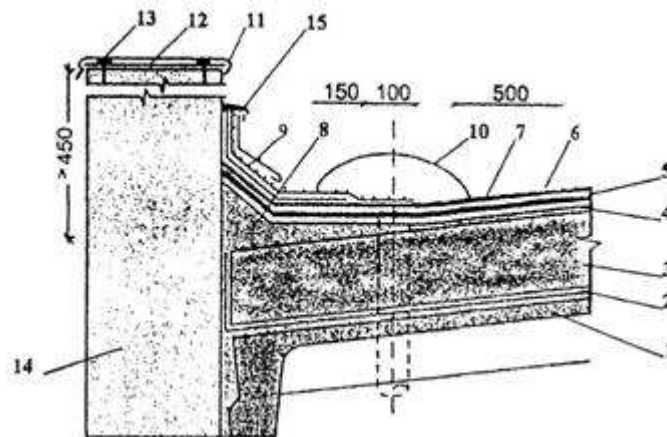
Примыкание кровли к парапету высотой более 450мм
